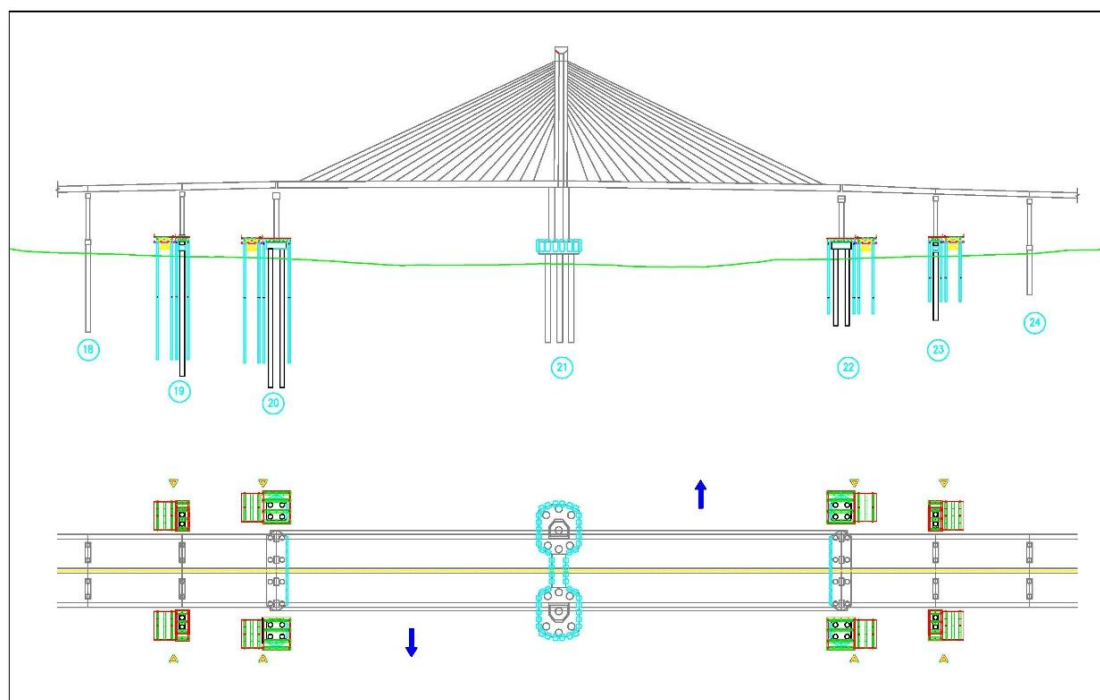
横琴大桥防撞设施施工平台总体方案布置图
